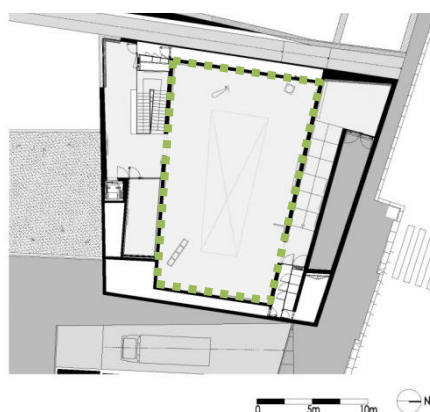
Centro Graça Morais, planta sala expositiva piso 1
